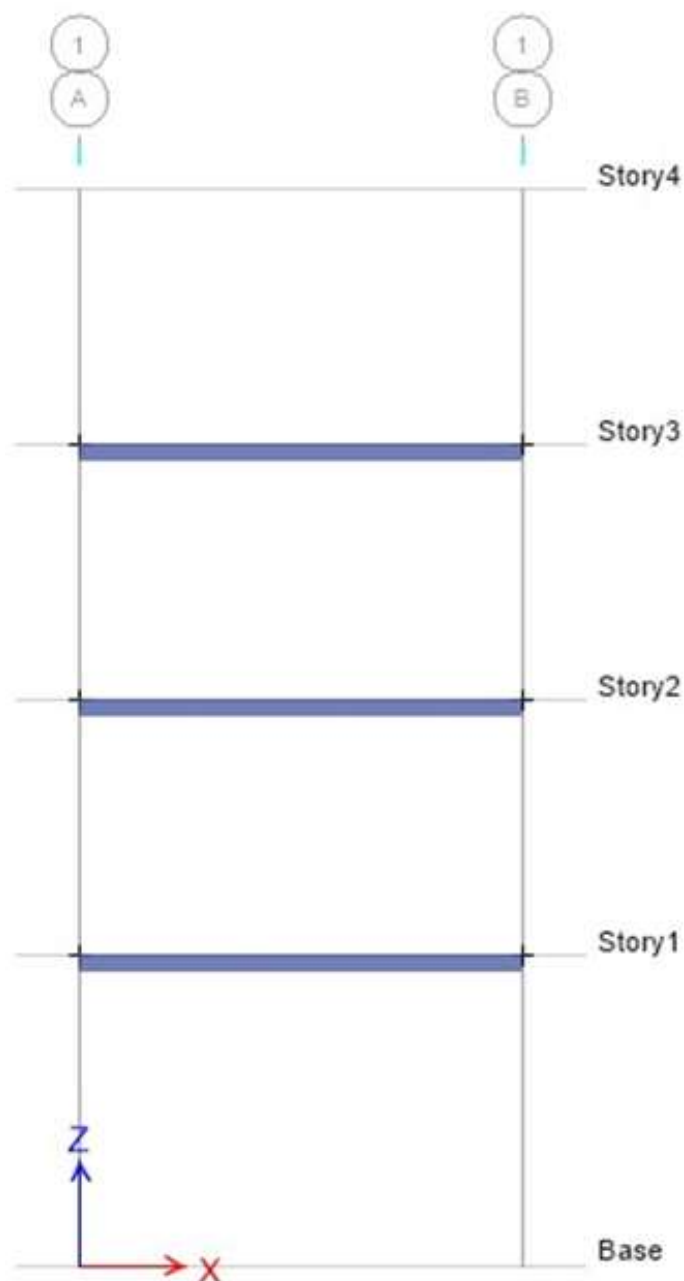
Modelamiento estructural de la estructura de AC, con vista en planta, entrepiso 1
